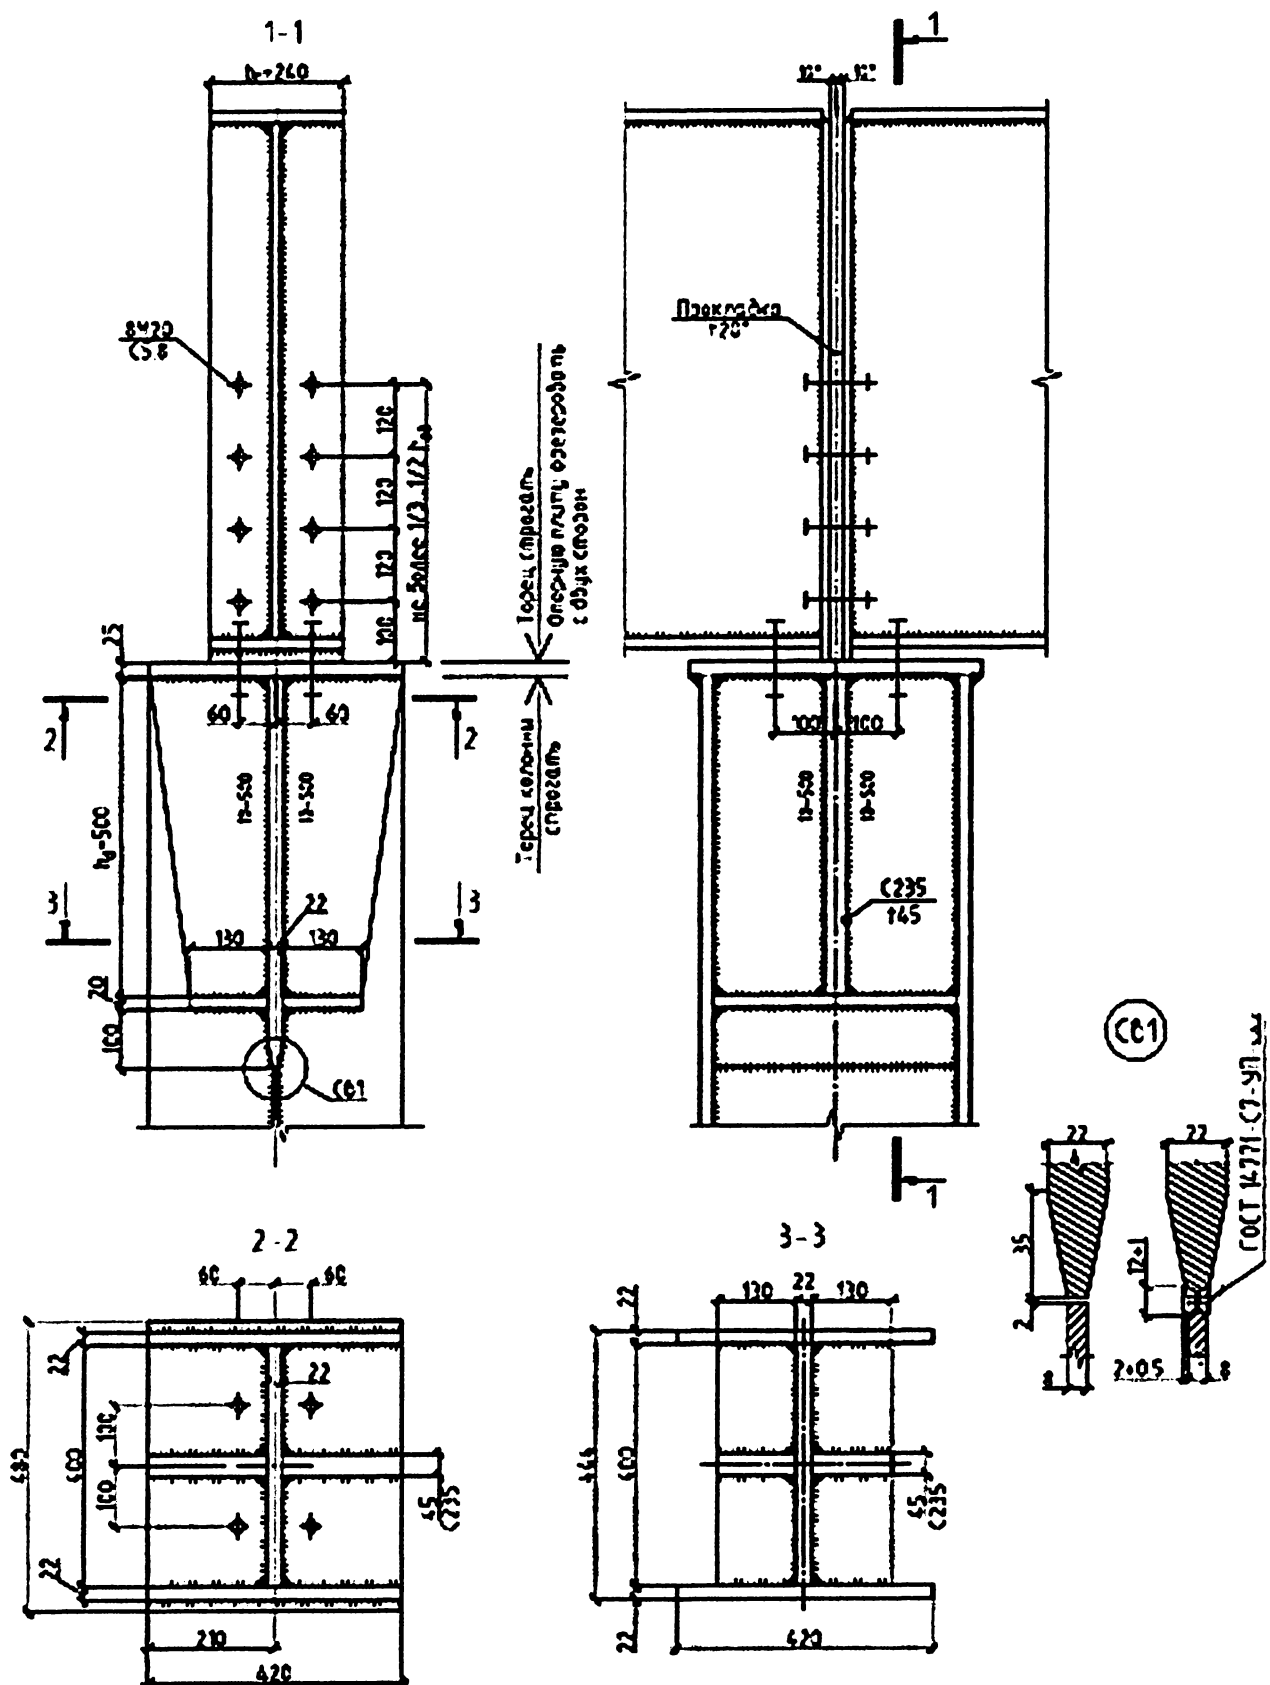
Оголовек сплошной центрально-сжатой колонны
